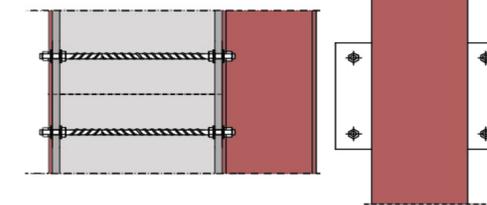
prospetto sistema di ancoraggio, SCALA 1:10.
